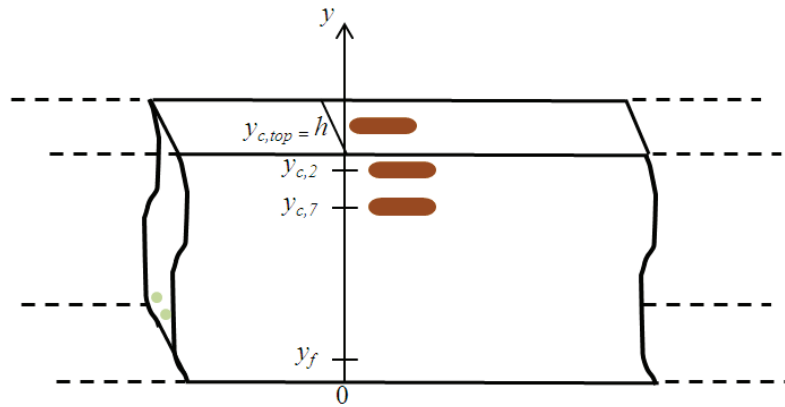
Positionnement vertical des jauges le long de la section centrale de poutre
